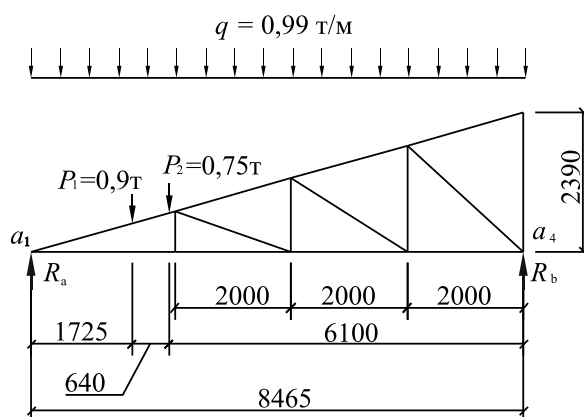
Исходная расчетная схема фермы Ф-1
